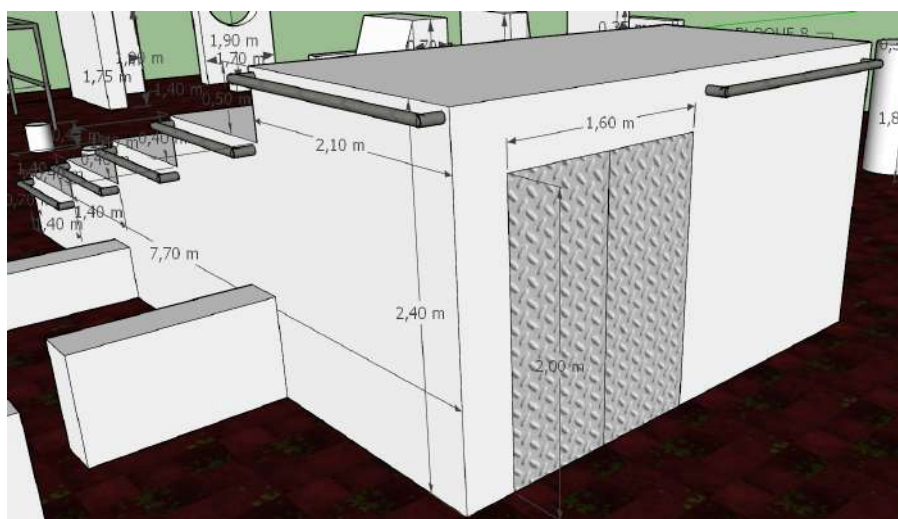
Vista del sexto bloque, la puerta del almacén.
